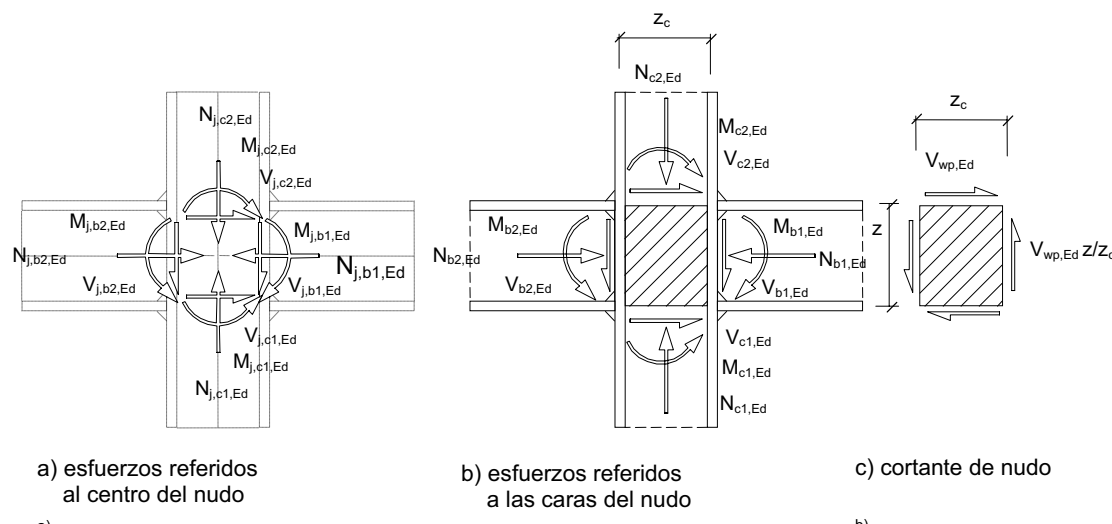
Unión (soldada o atornillada) y cortante de nudo
